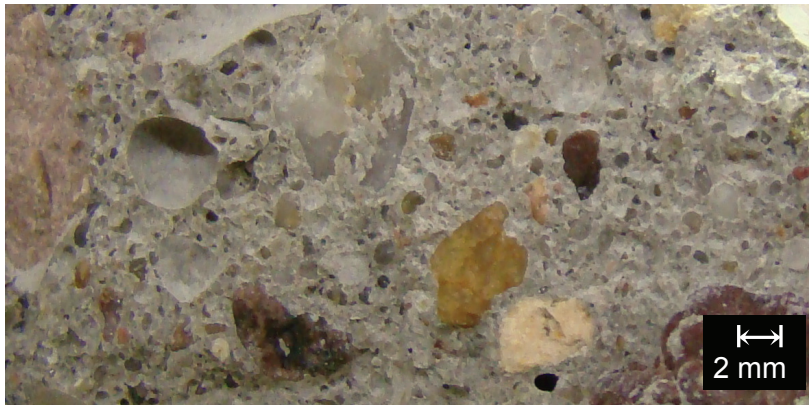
Bruchfläche eines unbewehrten Betonbalkens B55 nach Biegezugbeanspruchung
